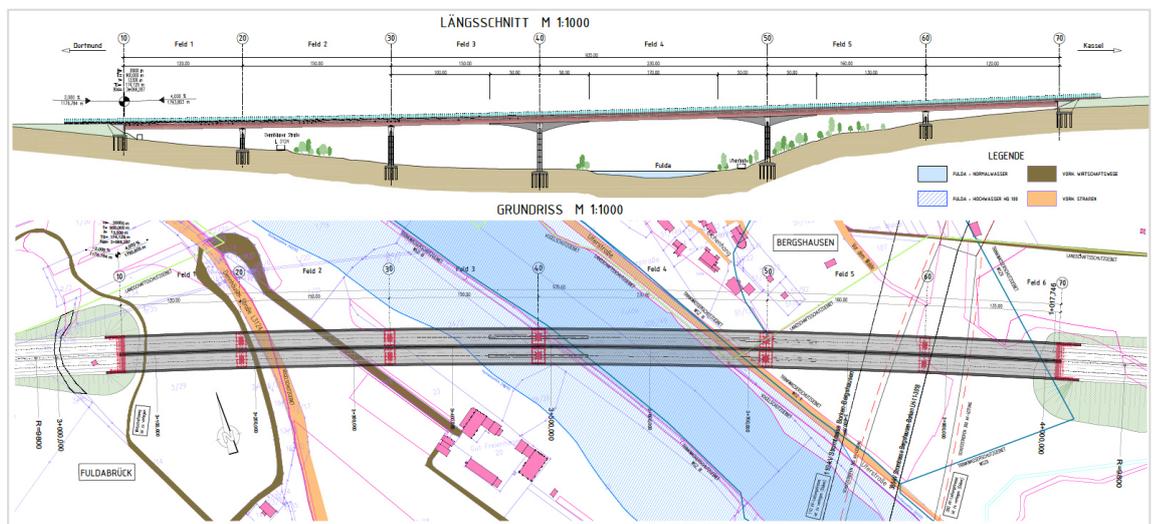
Längsschnitt und Grundriss der geplanten Bergshäuser Brücke (BW 07) in Variante 2 (Quelle: SCHÜBLER-PLAN 2019A)
